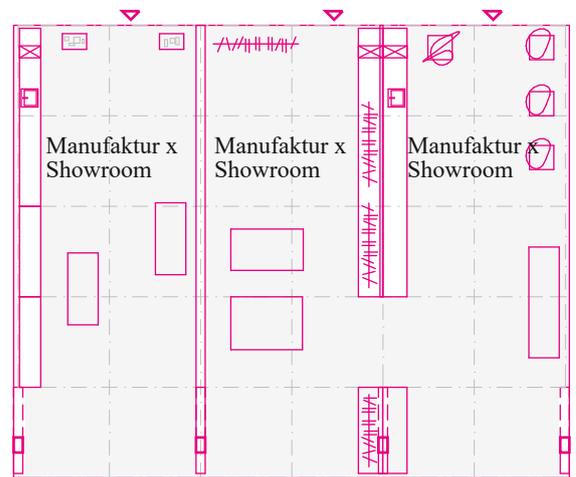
Grundriss Untergeschoss, M 1:250
